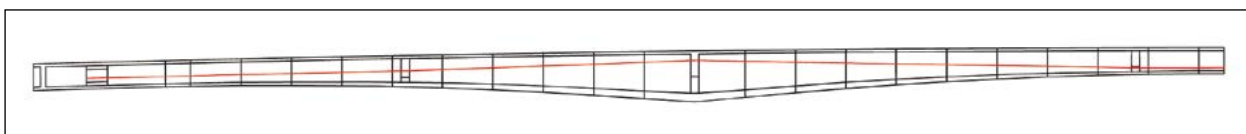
Câbles additionnels régnant sur toute la longueur de l'ouvrage
